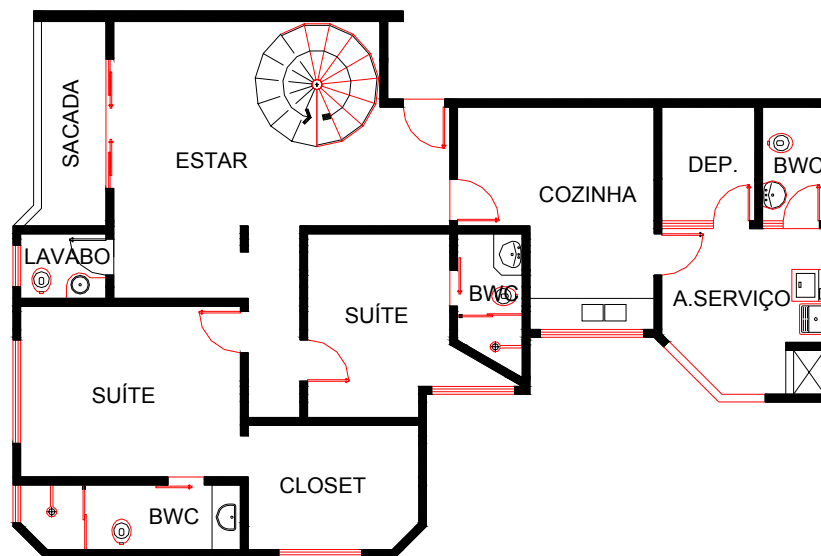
Planta Baixa do pavimento inferior do apartamento 1002 – Estudo de caso B. (Apartamento Duplex).
